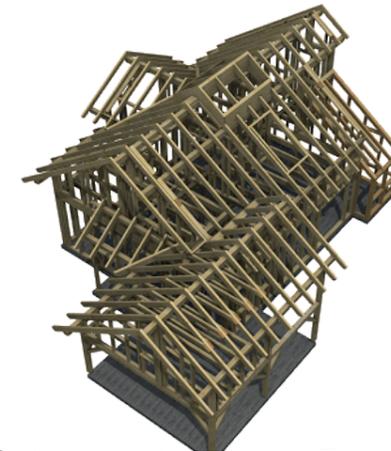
Sistemas estructurales. Tomado de (Estructura como espacio arquitectónico, 2010)
